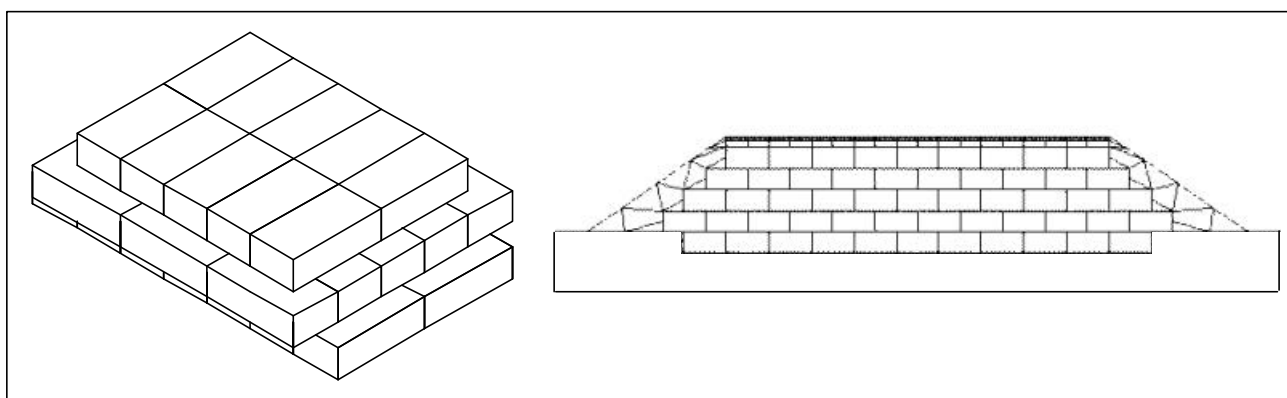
Disposizione dei blocchi di EPS in un rilevato stradale.
